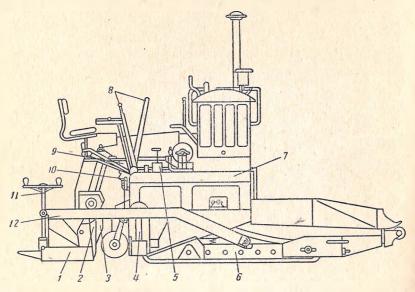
Схема общего вида асфальтоукладчика Д-150Б (вид сбоку): I— разглаживающая плита: 2— трамбующий брус; 3— отражательный щит; 4— гидравлический подъемник; 5— топливный бак; 6— ходовая часть; 7— рама ходовой части; 8— рычаги управления; 9— гидронасос; 10— пружинная подвеска несущих рычагов; 11— регулятор толщины; 12— несущие рычаго
